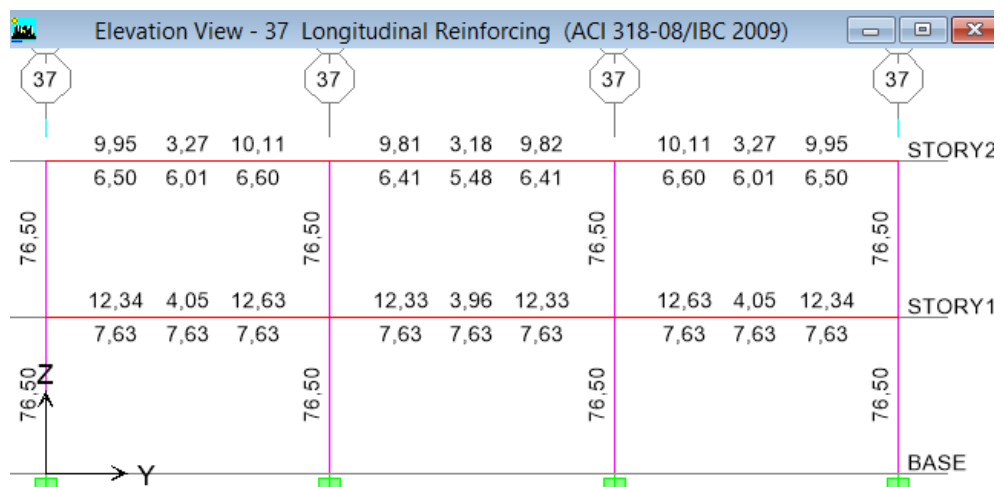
Acero en Vigas y Columnas en el Pórtico 37 – Obstetricia - (CEC2002)
